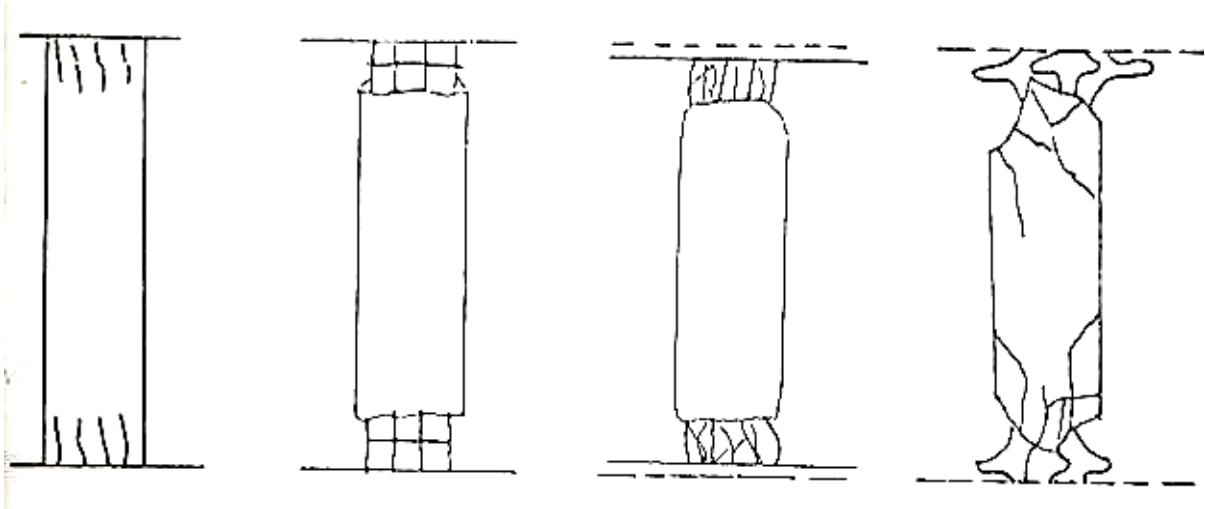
Kolonda İleri Derecede Kesme Kırılması
